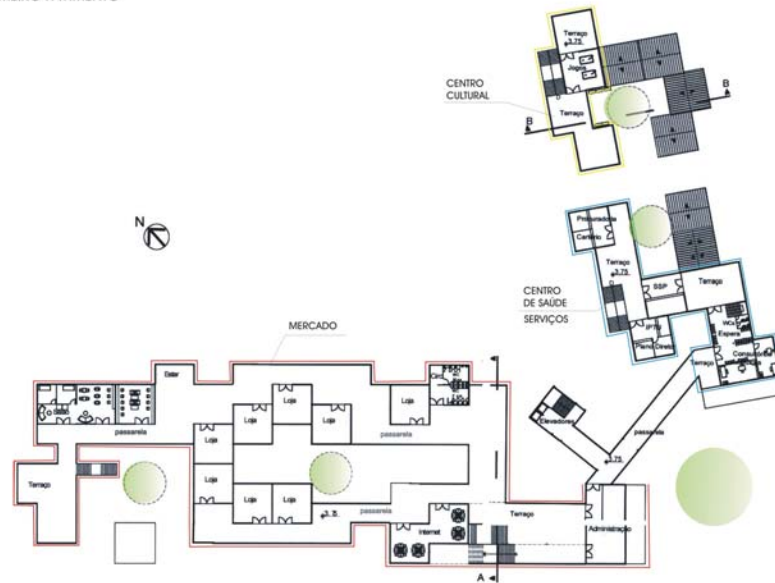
Planta Baixa do Primeiro Pavimento
